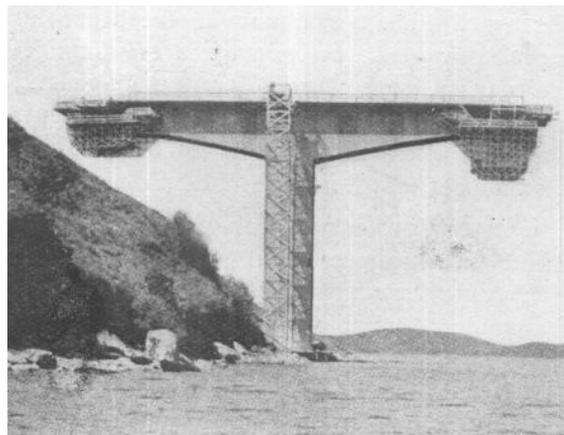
Construcción del puente Kalløsound, Noruega.
